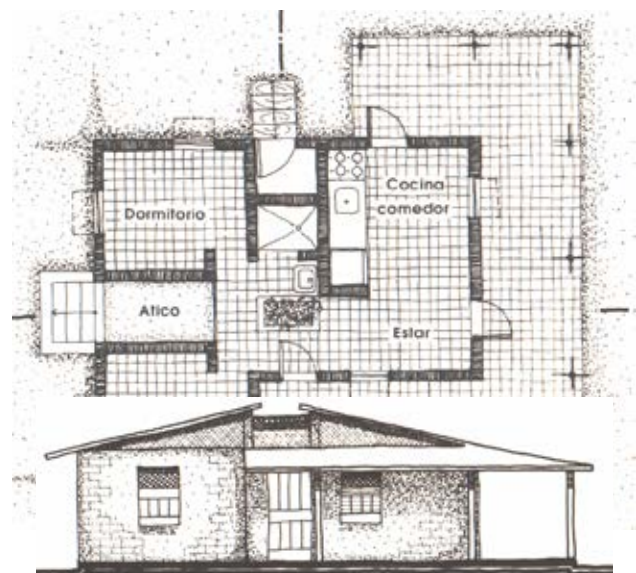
Planta Arquitectónica y fachada de la vivienda tipo.
